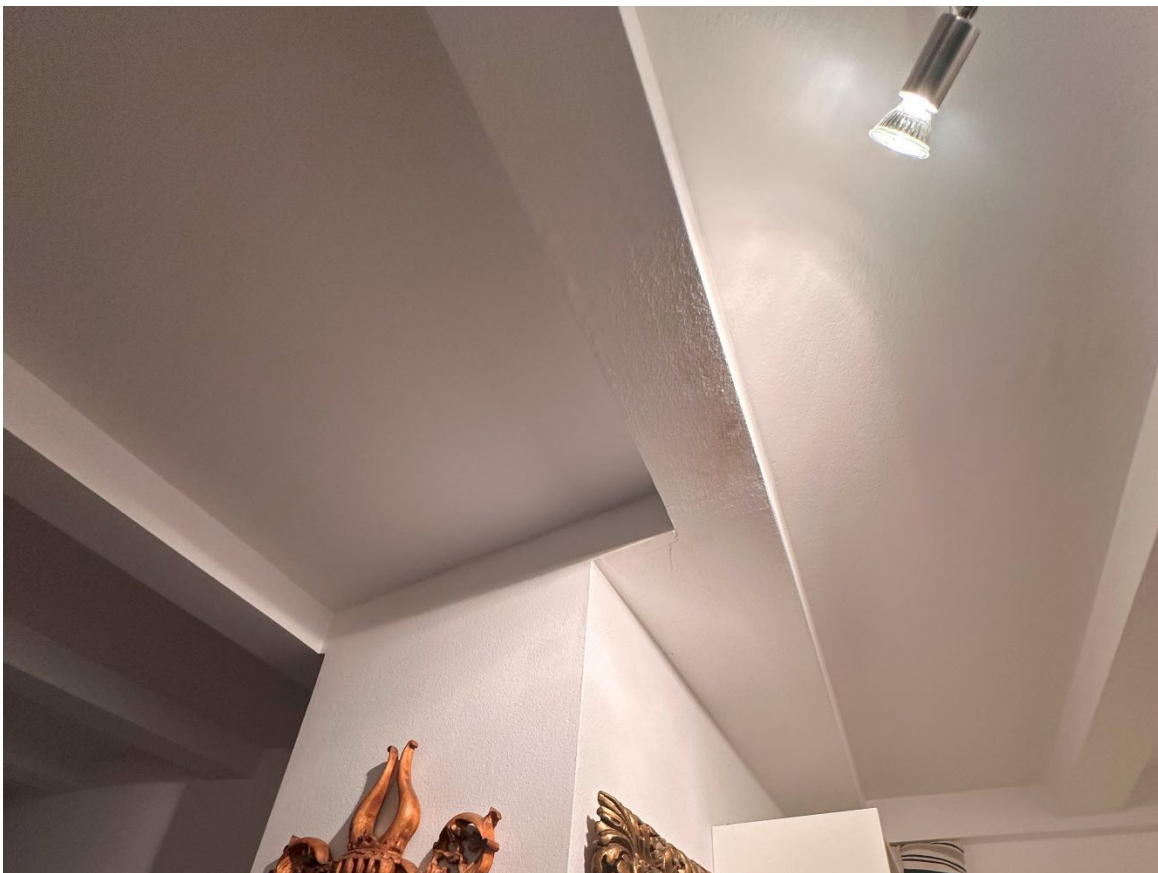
Wohnung Top D 3 | Wasserschaden Gang
